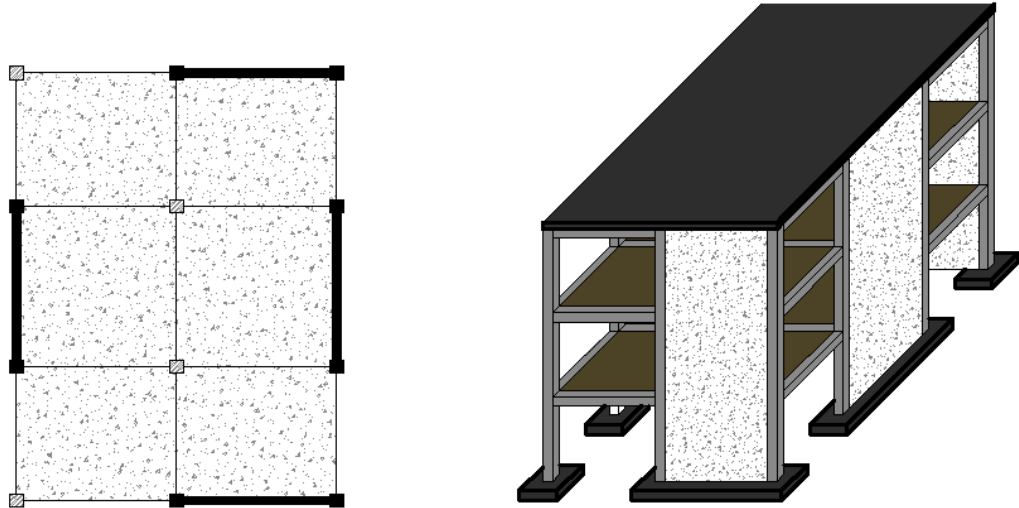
Muros de corte de hormigón armado en edificaciones.
